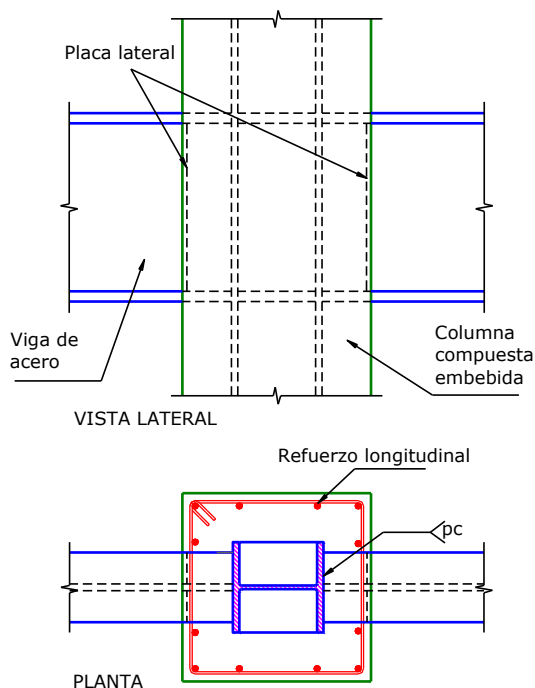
Detalle de la conexión una viga de acero y una columna compuesta embebida.
